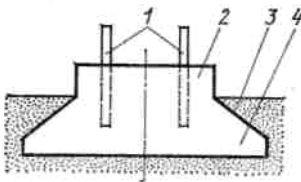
Фундамент печі: 1 – анкерні болти; 2 – опора;
